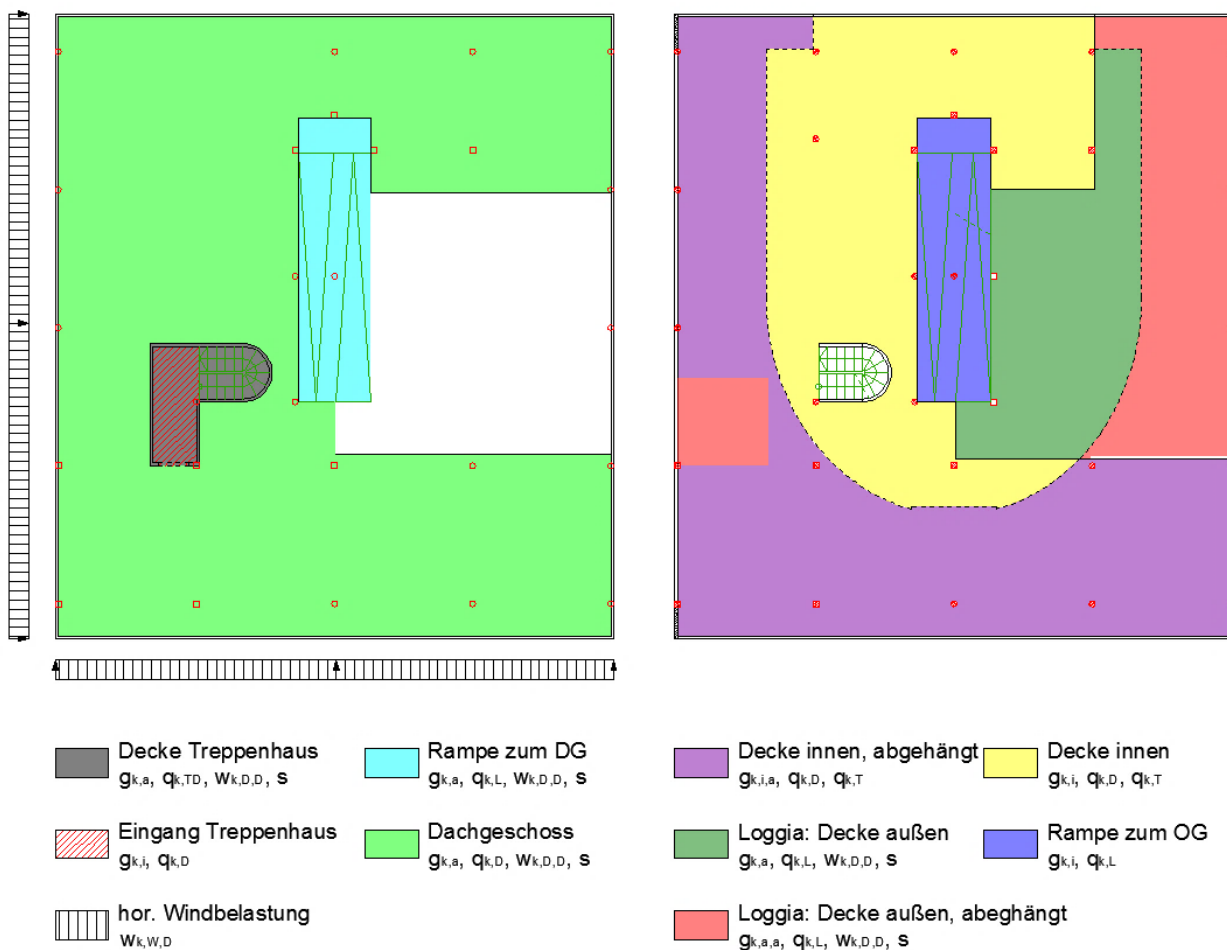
Unterteilung der Belastungen im Grundriss: Dachgeschoss (links) und Obergeschoss (rechts)
